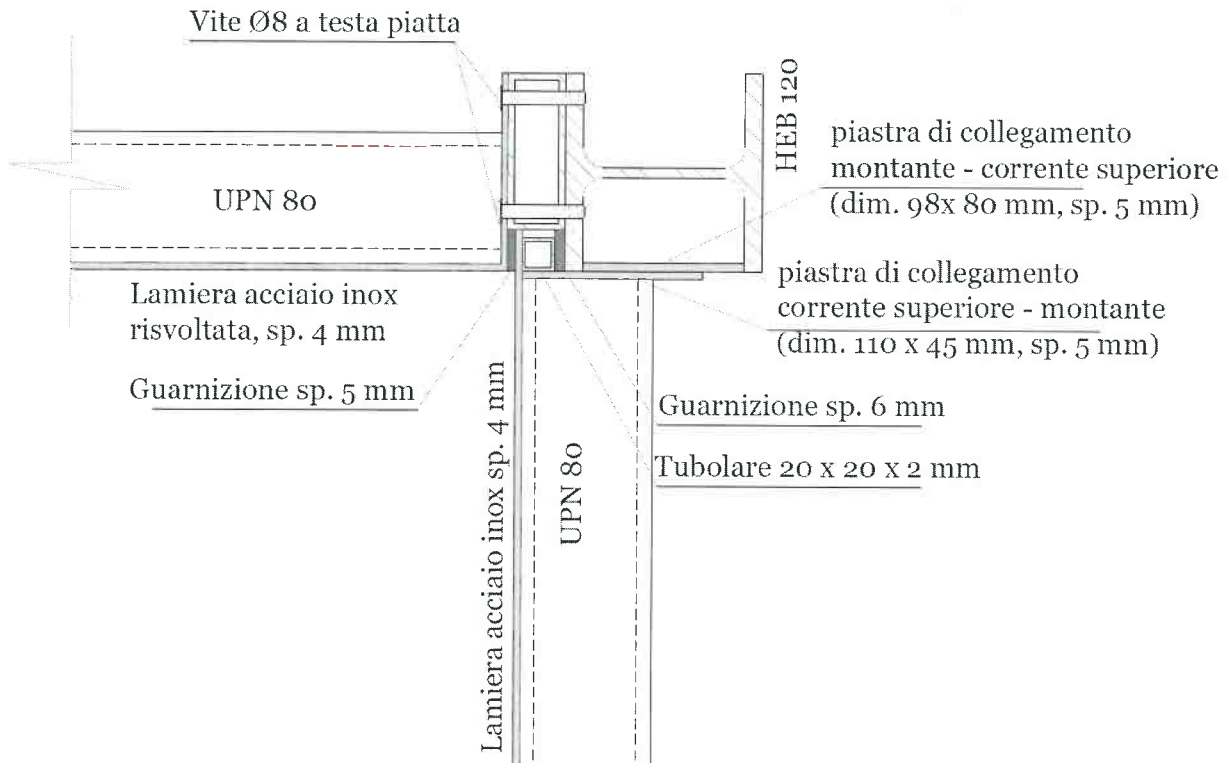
Particolare sezione in pianta sistema di tenuta a “wafer” per parete laterale tipo 2
